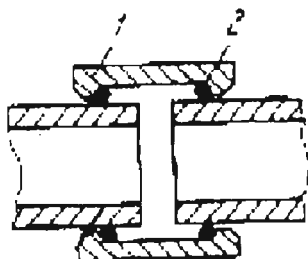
Соединительная муфта (1) с уплотнительными кольцами (2)
